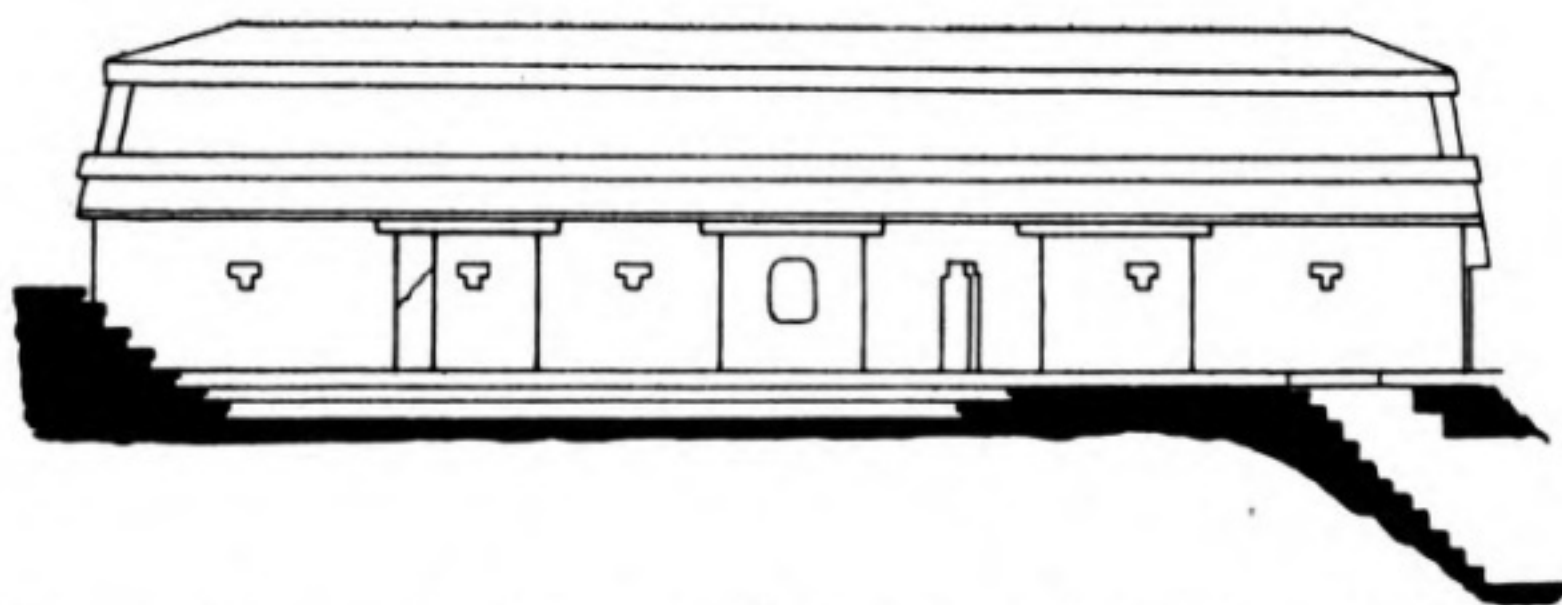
Palenque, Palacio. Alter Bau mit den Malereien (Haus *E*, Maudslay). Außenwand der Westhalle. (Nach Maudslay IV, Pl. 41.)
